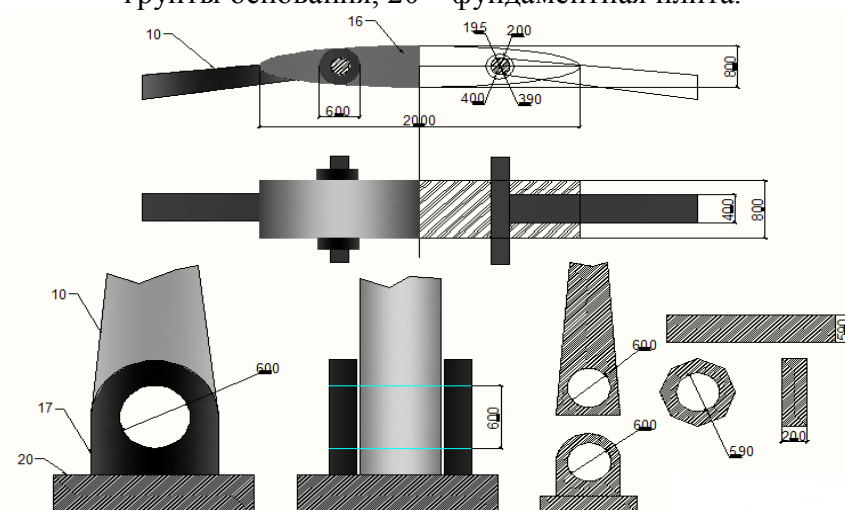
Узлы Е, F: 10 – металлические балки-арки, 16 – шарнирный узел кровельного сопряжения арок, 17 – шарнирный узел наземного сопряжения арок, 20 – фундаментная плита.
